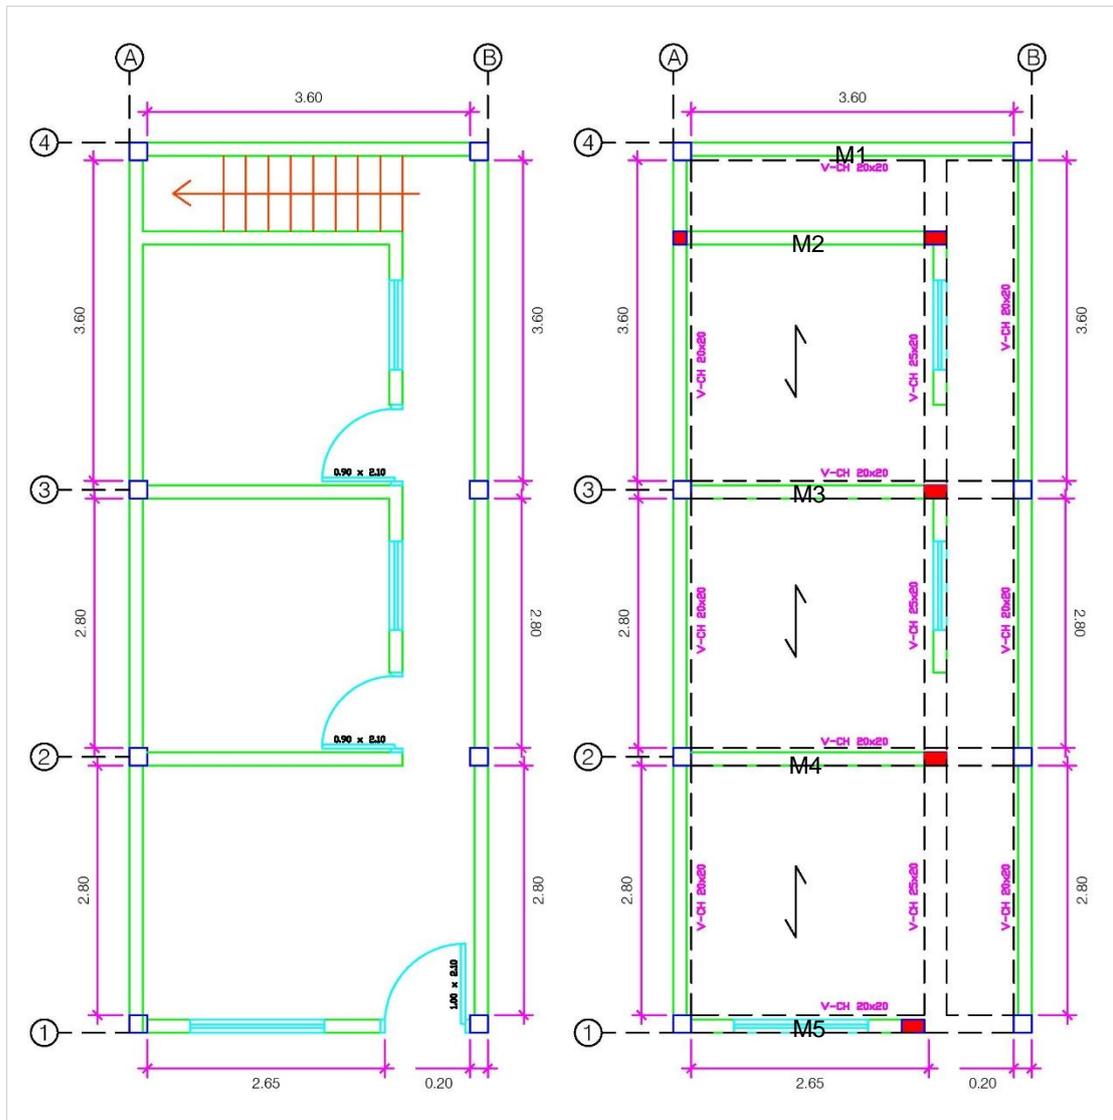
Planta – vivienda N°2, estado actual y propuesta de refuerzo
